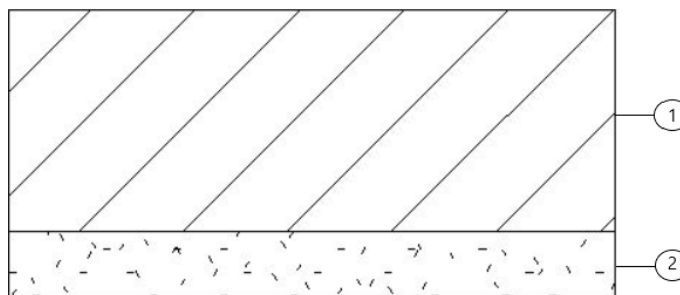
Pormenor da constituição da parede externa tipo E1
